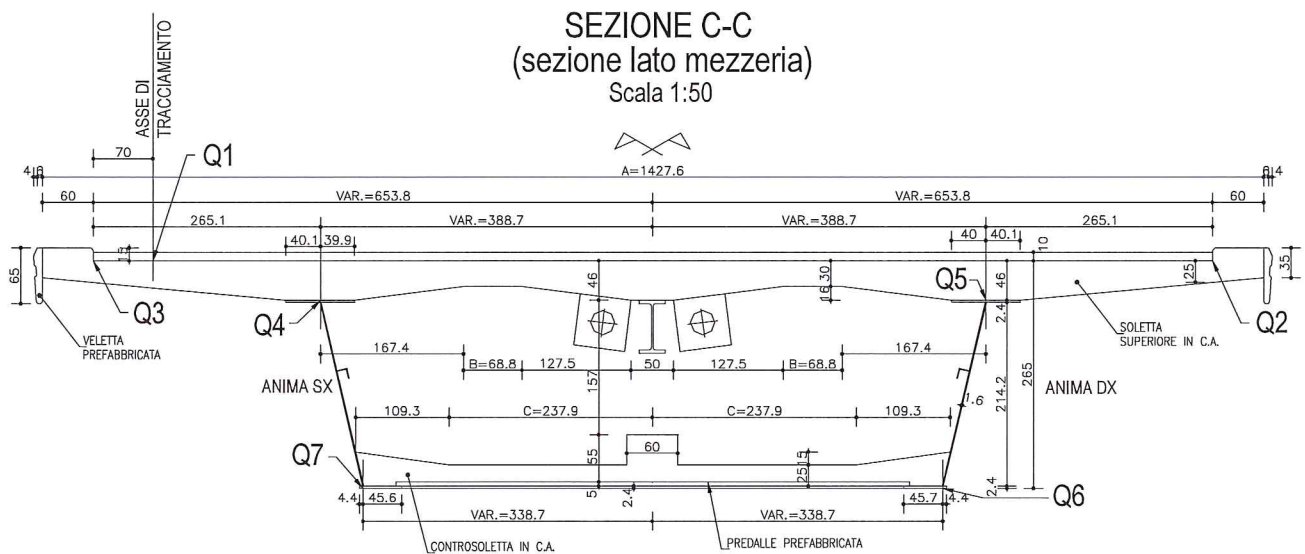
Concio 5 – Sezione trasversale impalcato in allargamento.
